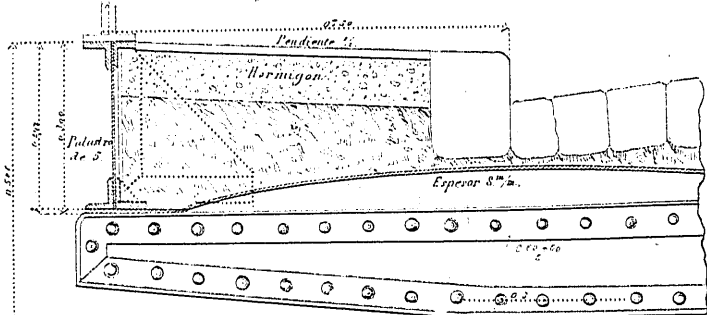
Viga central con rostras y anillo superior de arrojamiento de los Pilotes.
